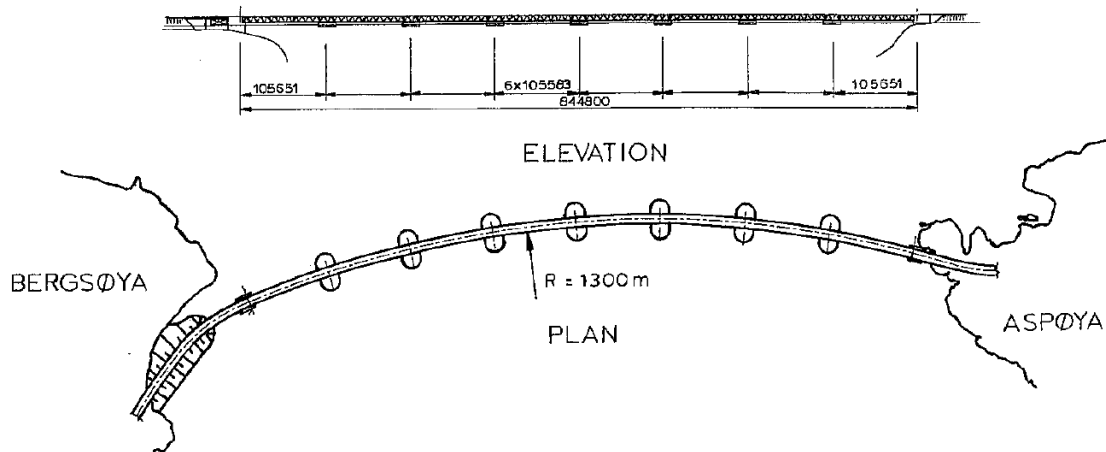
Grundriss und Ansicht Bergsøysund Brücke (Solland, et al., 1993)
